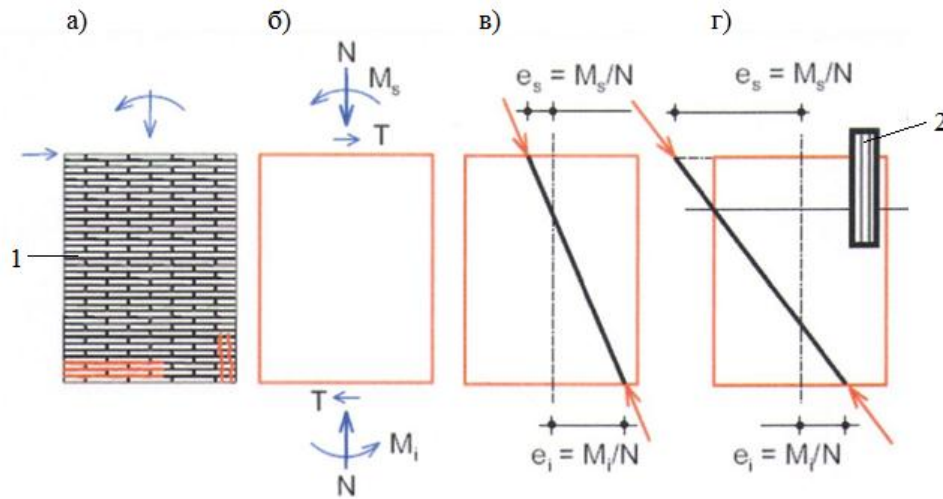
Армирование сетками из композитных материалов торцевой стены исторического здания, подверженного сейсмическим воздействиям [37]
